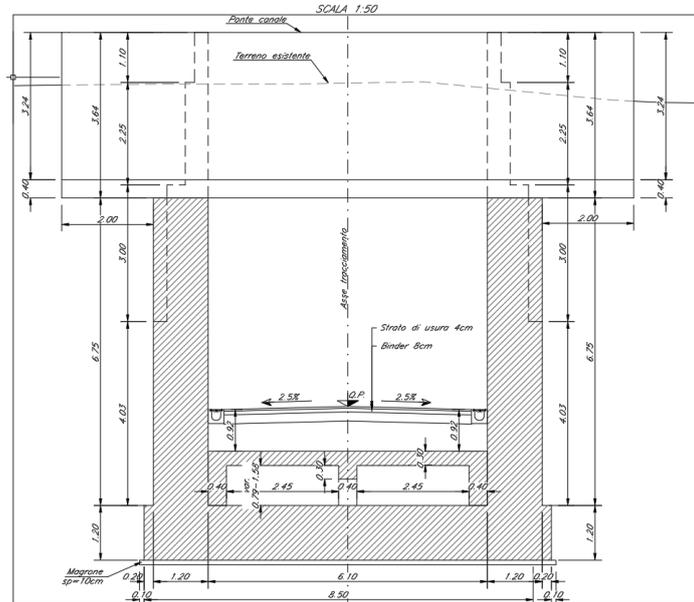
Sezione trasversale conco 1 est, in corrispondenza del ponte canale
